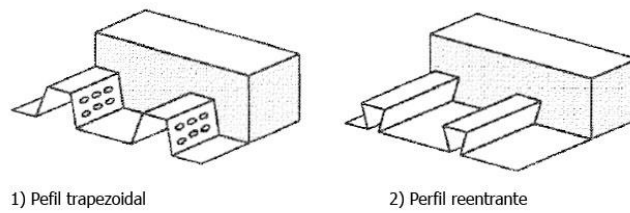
Tipos de chapas perfiladas (adaptado [2][1])
